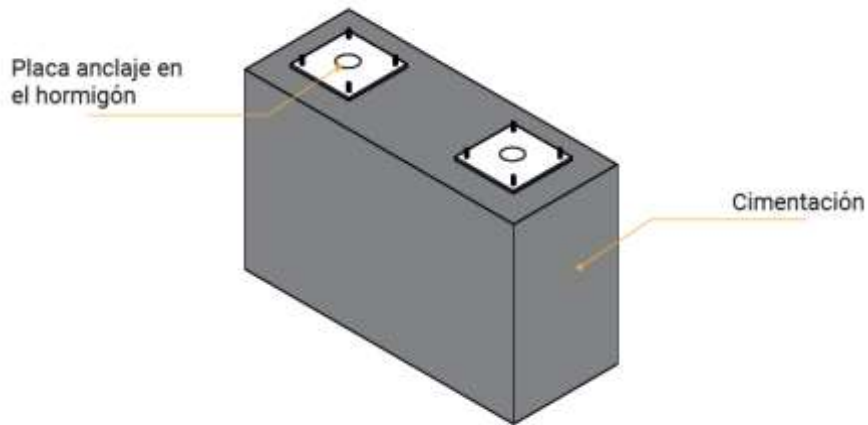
Ejemplo de bloque de hormigón para el anclaje de los soportes de los paneles radiactivos
